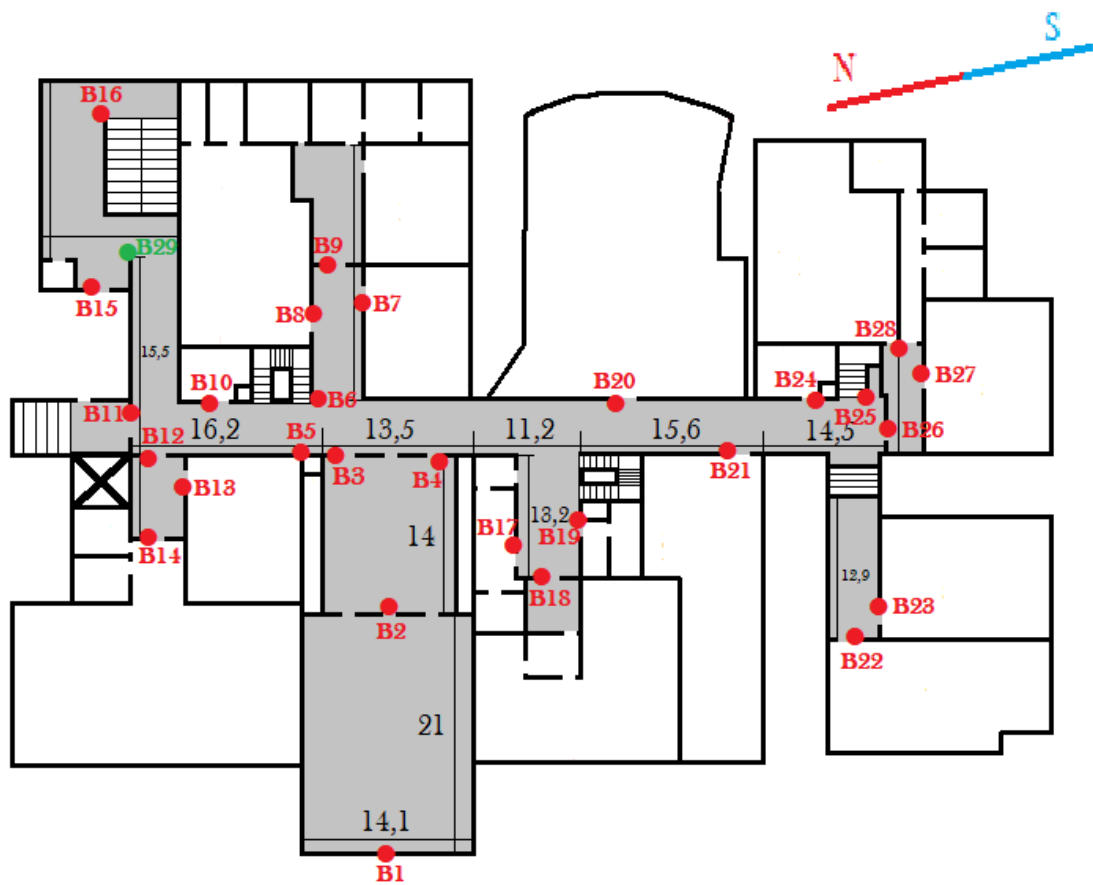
Plano con la ubicación de las balizas en la planta baja de la EII sede Fco. Mendizábal. Solución 1.
